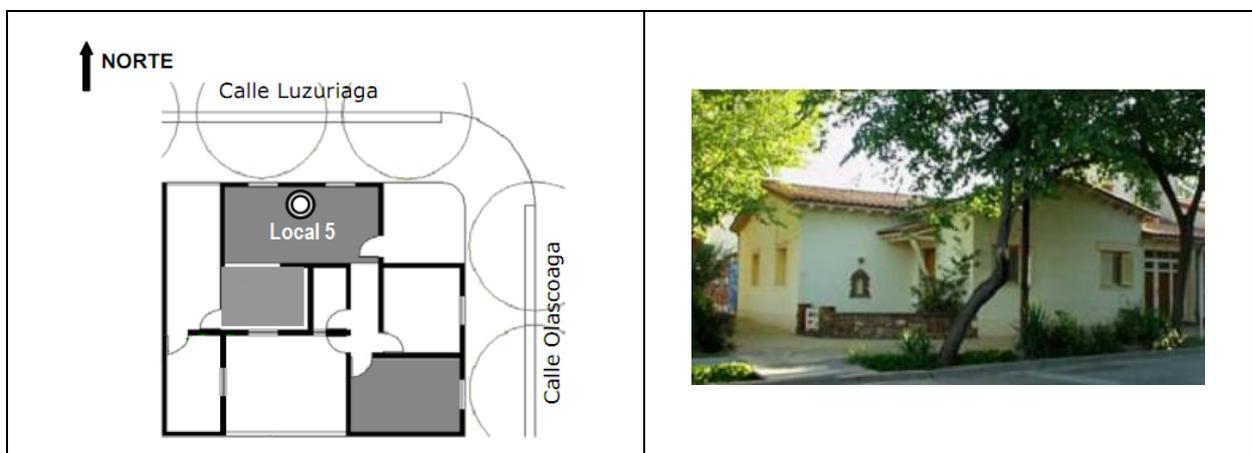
Planta y vista de la vivienda desde el Norte. Adaptada de: Ganem (2006).
